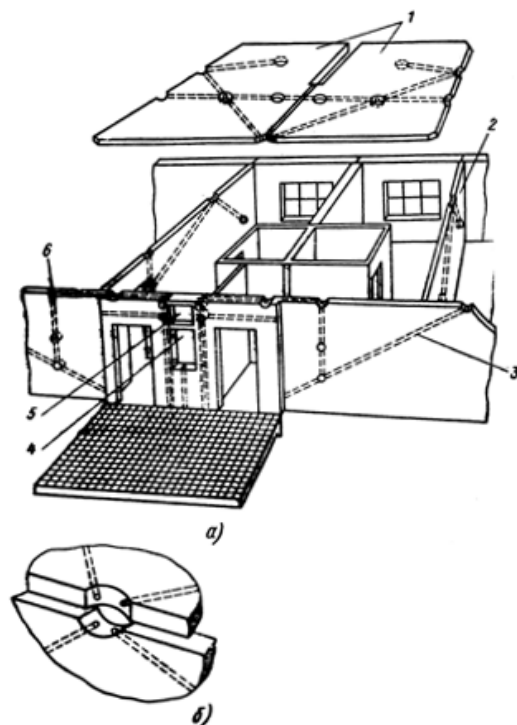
Пример выполнения электропроводки в каналах панельного дома а) общий вид квартиры, б) сопряжение каналов стеновой панели
